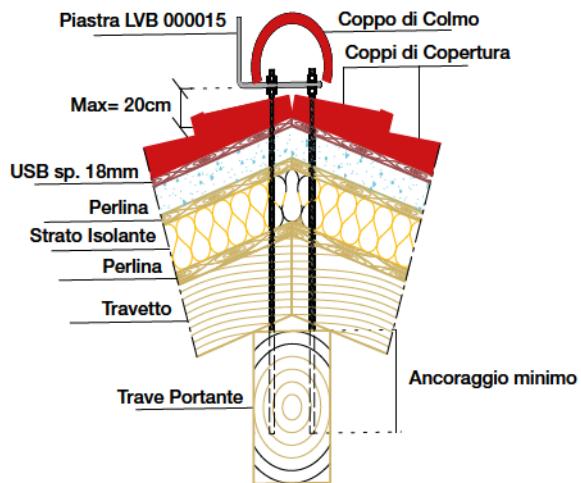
Sezione del dispositivo LVB fissato su struttura di supporto in legno.
